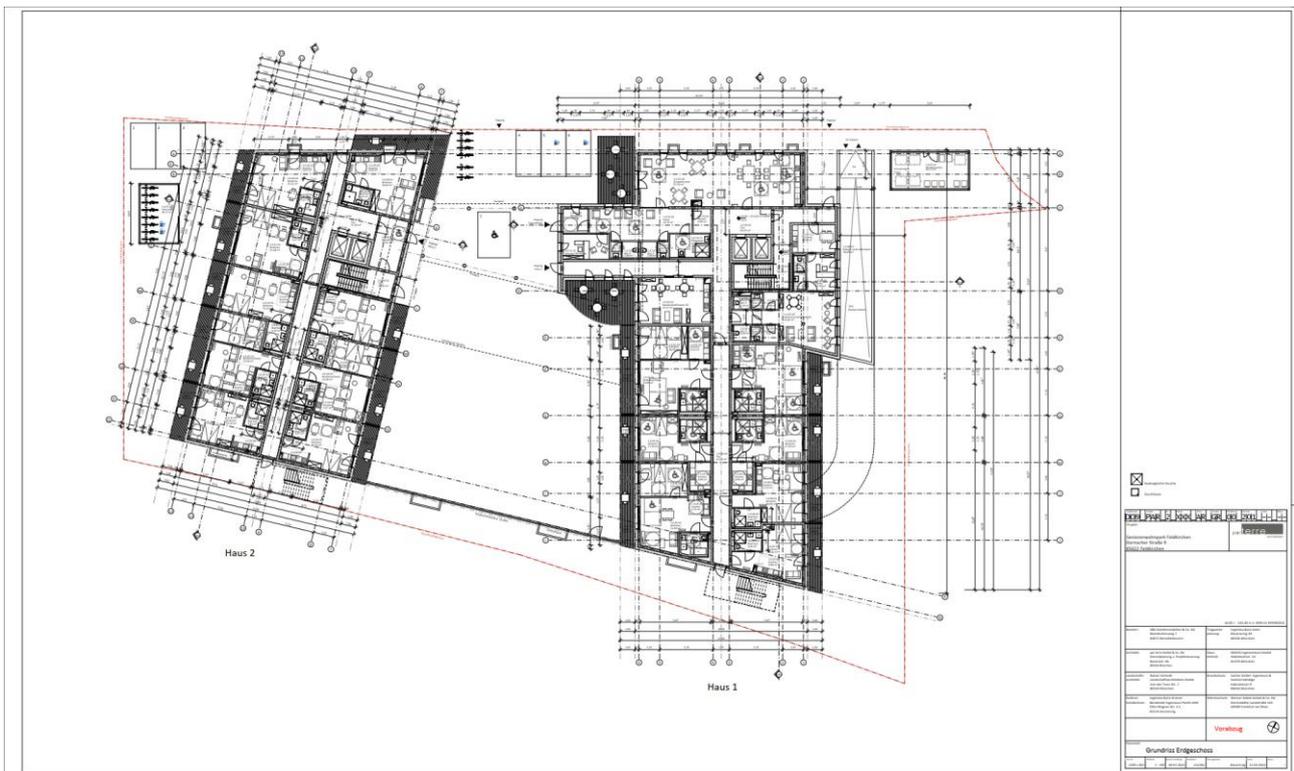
Grundriss Erdgeschoss – Seniorenwohnpark Feldkirchen [par terre architekten, Stand: 21.04.2022]
